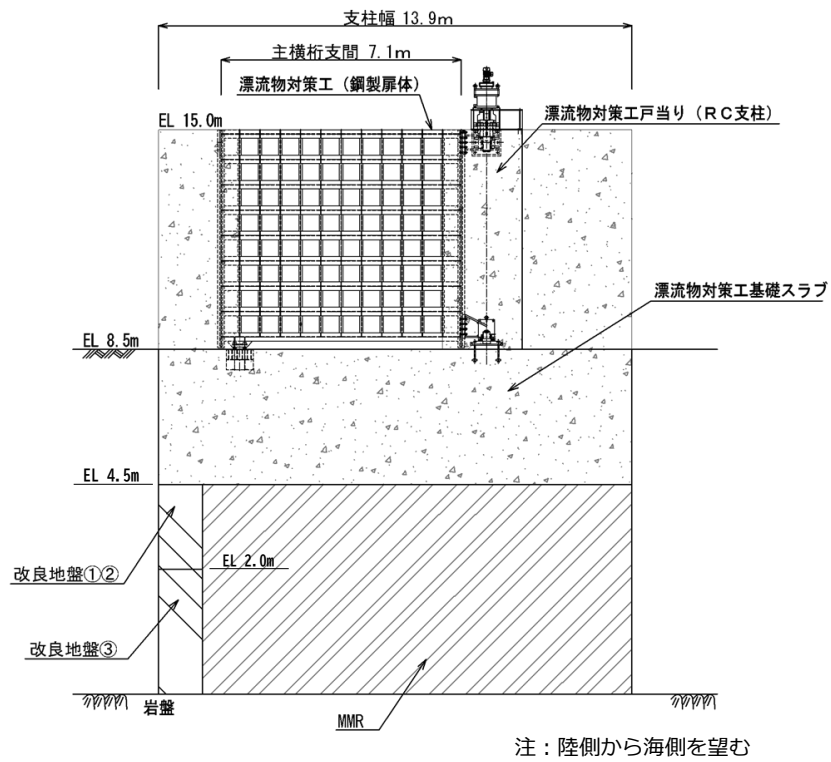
(1) 漂流物対策工の構造図(基礎正面図, A-A断面)
